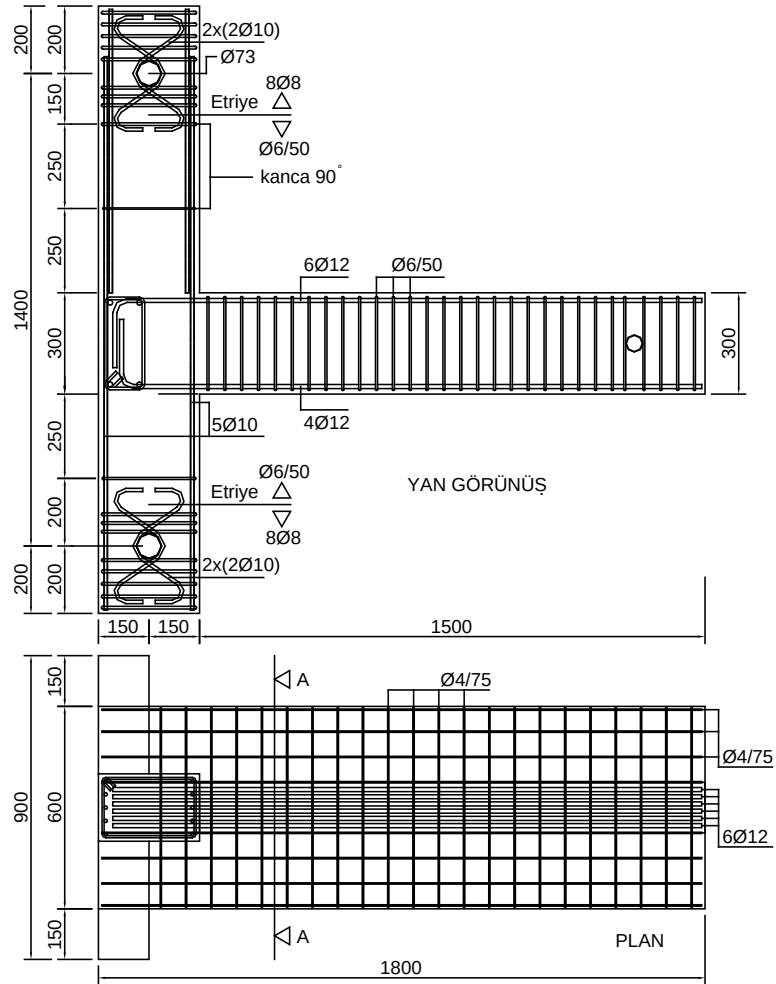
WC1a elemanı donatı detay çizimleri
